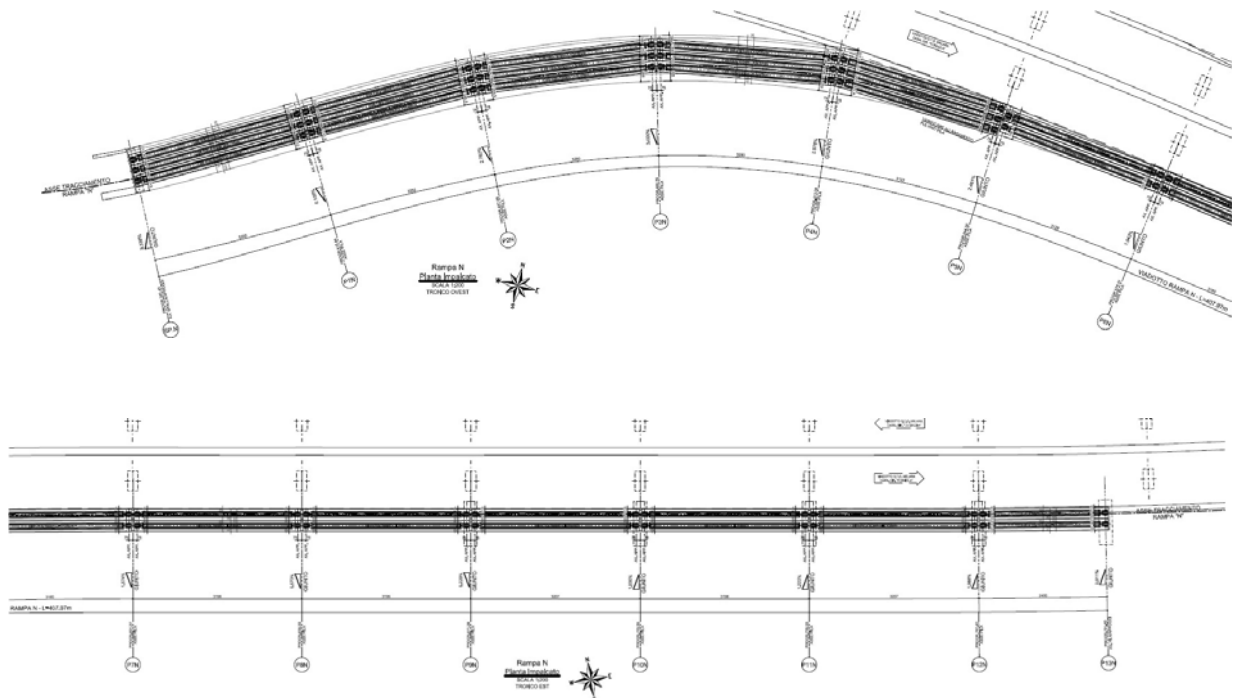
Planimetria Rampa N svincolo Melara
